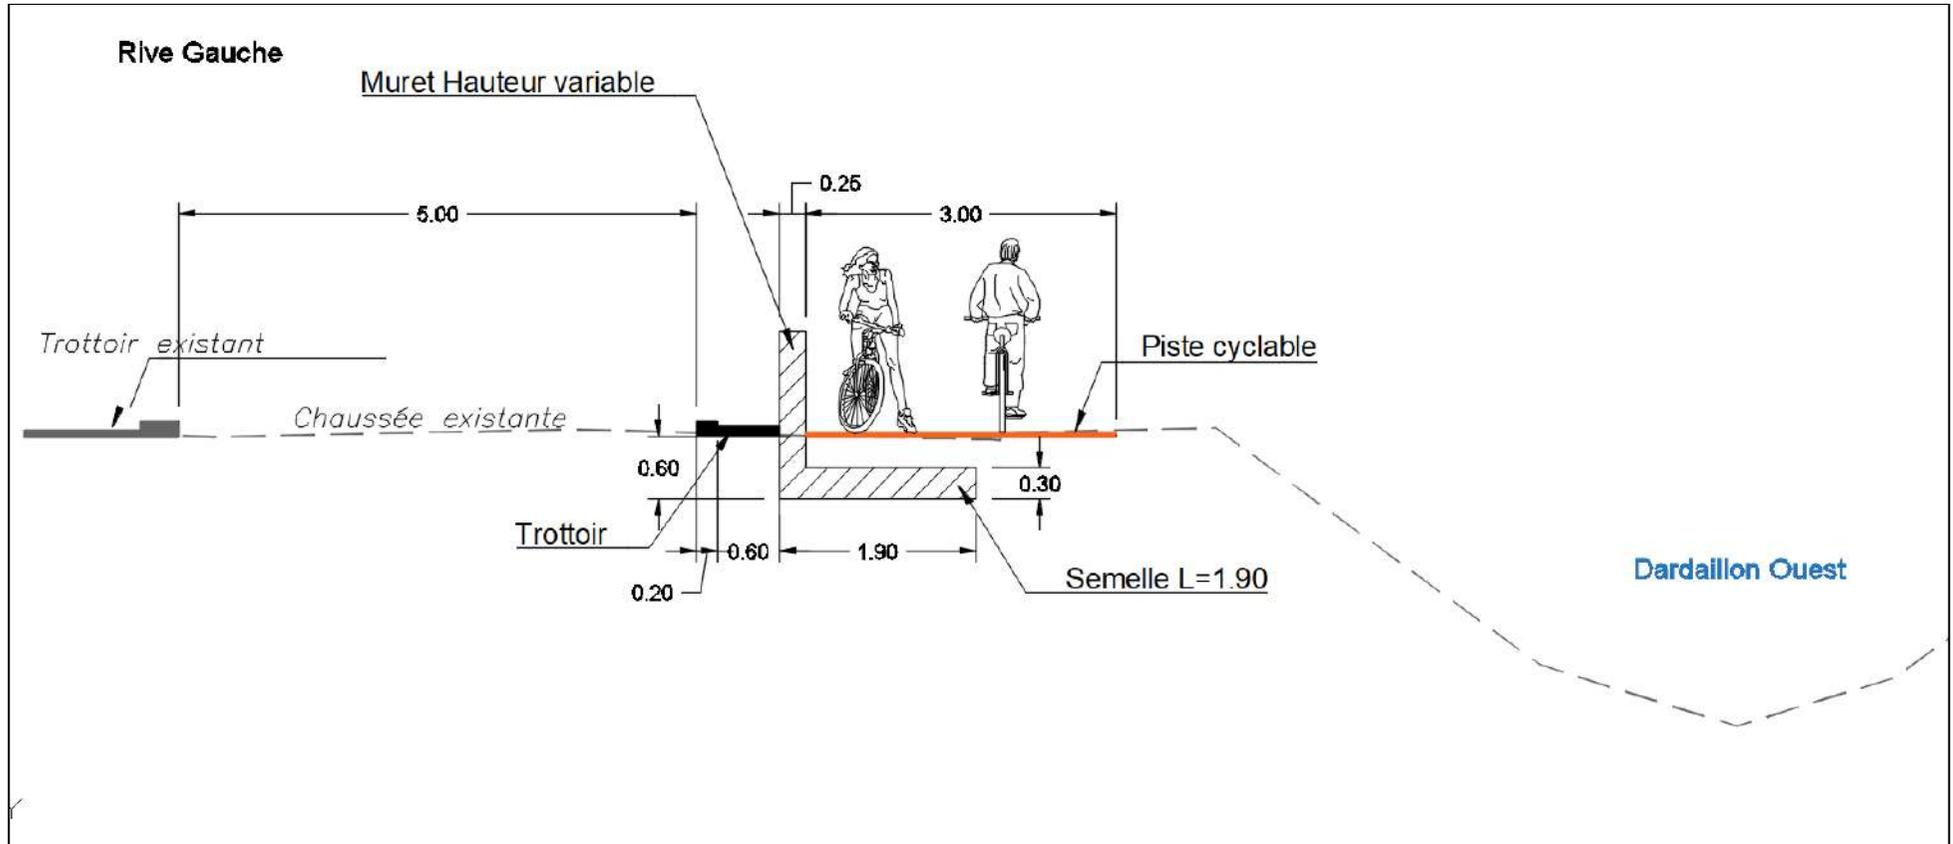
COUPE TYPE DU MUR DE PROTECTION
